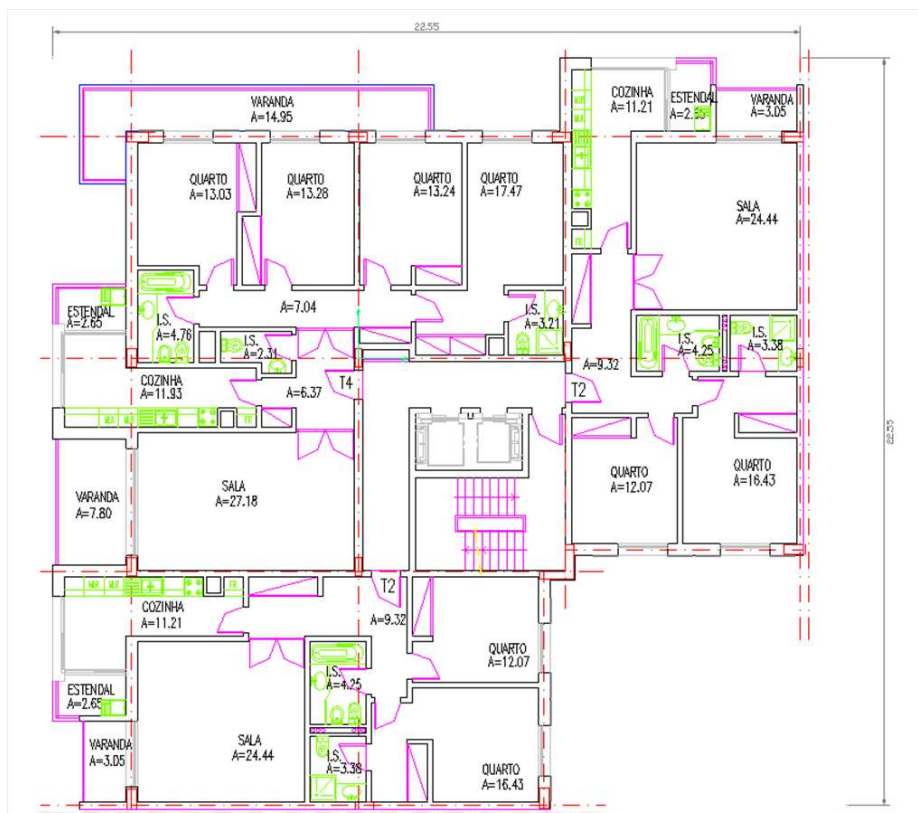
Planta de Arquitectura do Piso tipo.
